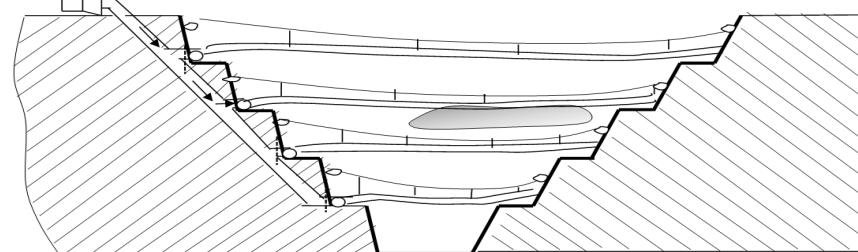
Вертикальный разрез карьера с трубопроводами для подачи воздуха
